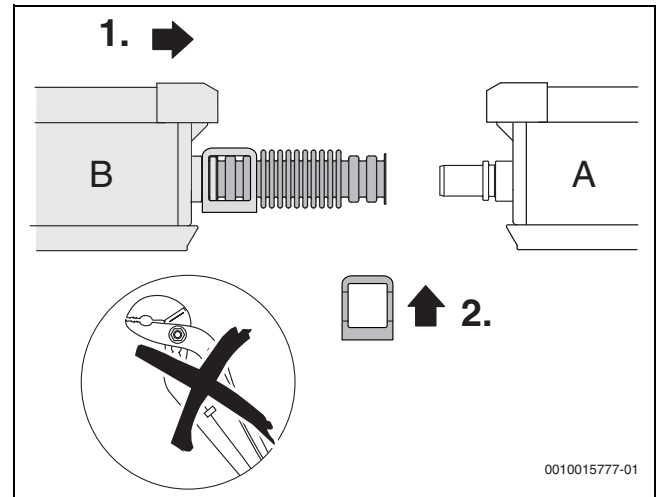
Colocar el colector izquierdo junto al colector derecho
